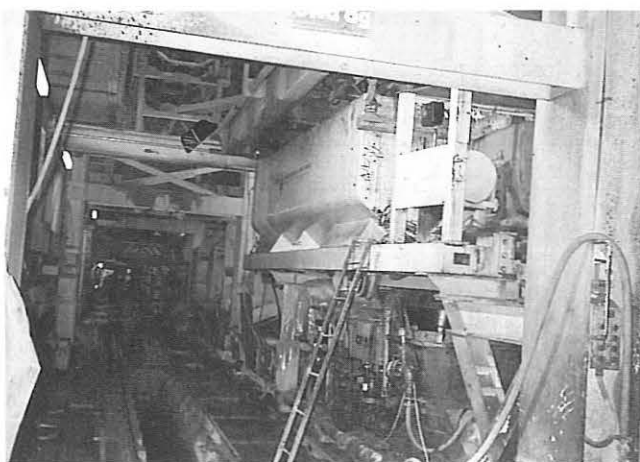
Naßspritzbetonumschlag in der Nachlaufkonstruktion, Baulos T4
